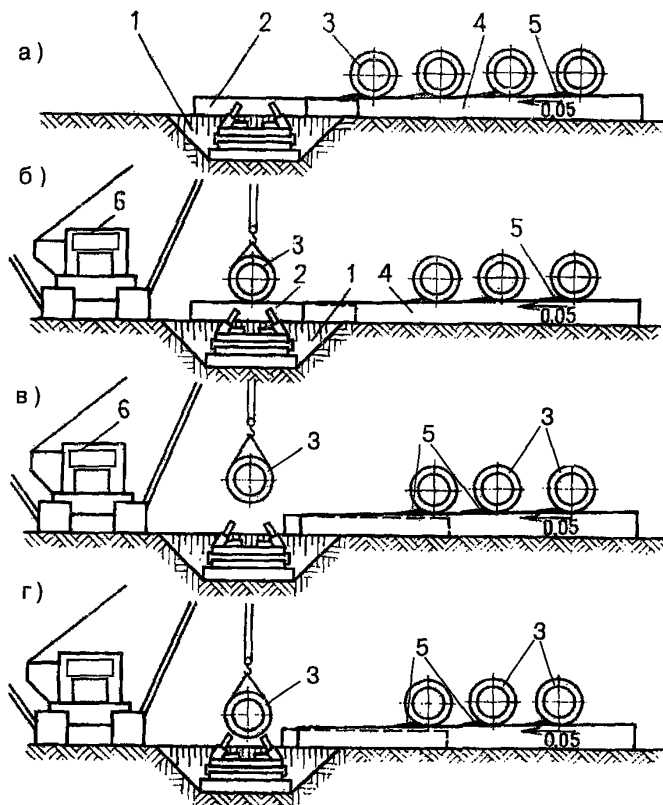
Схема установки плети трубопровода на роликовую дорожку:
